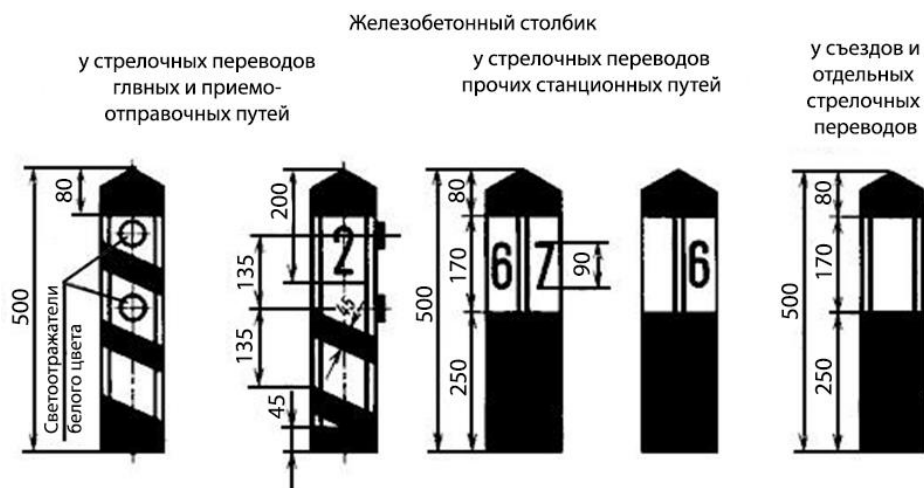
Внешний вид железобетонного предельного столбика
